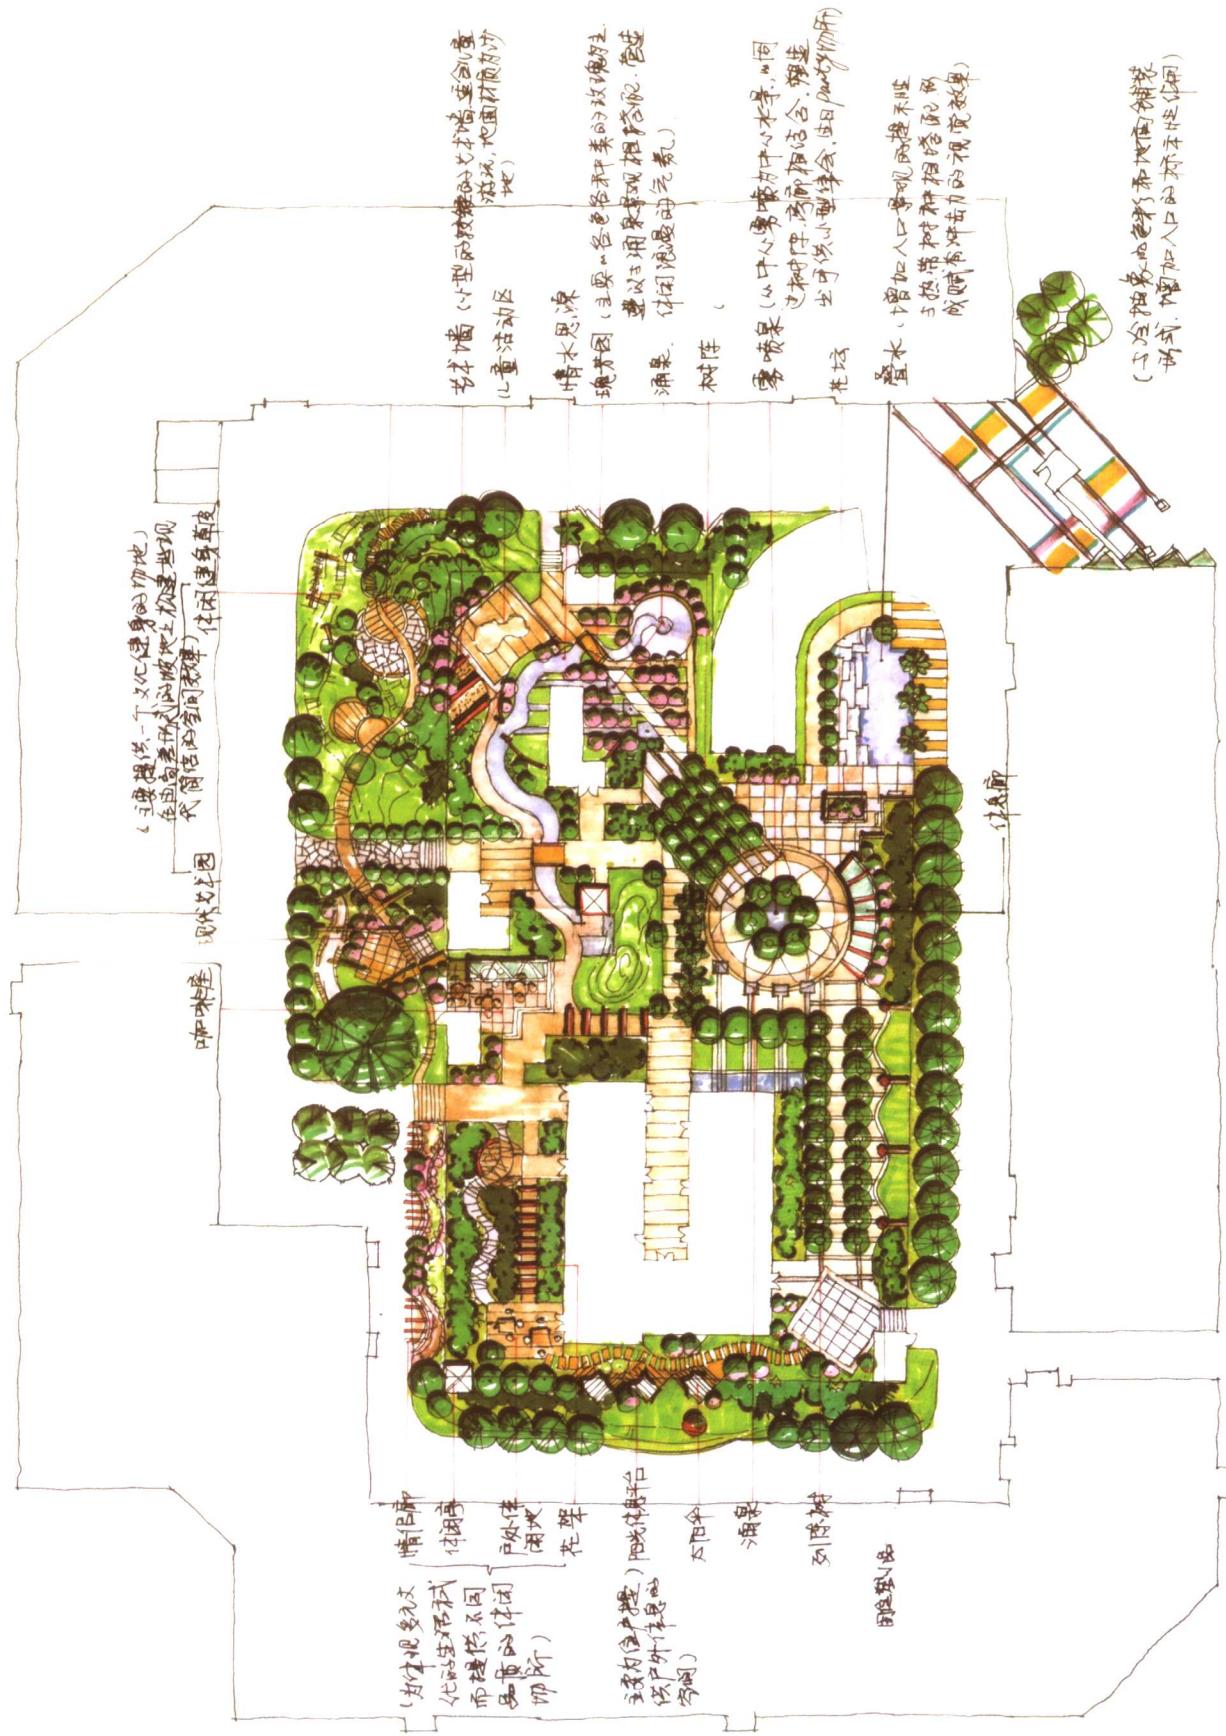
玫瑰苑小区平面图 • 马克笔 任刚
